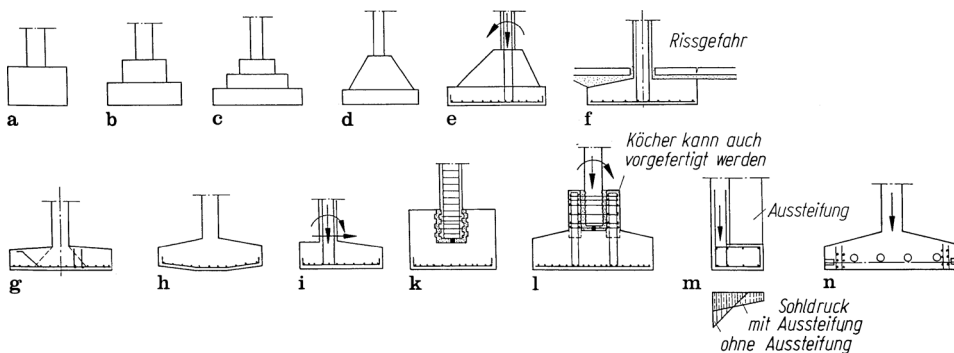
zeigt einige geometrische Formen von bewehrten und unbewehrten Fundamenten im üblichen Hochbau. Im Fall großer Abmessungen wurden früher zur Einsparung von Betonmassen und Bewehrung oft abgetreppte (Beispiele b und c) oder sich nach oben verjüngende (Beispiele d und e) Formen gewählt, während sich aktuell eher schlanke bewehrte Fundamente als wirtschaftlicher erweisen.
